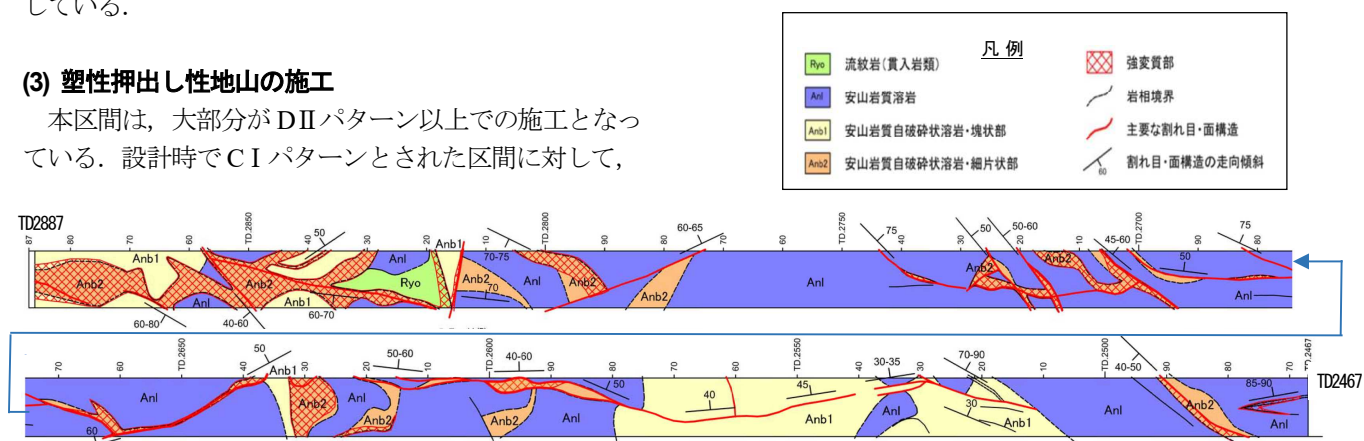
地質水平断面図 (SL) (TD2,467～2,887 m)
